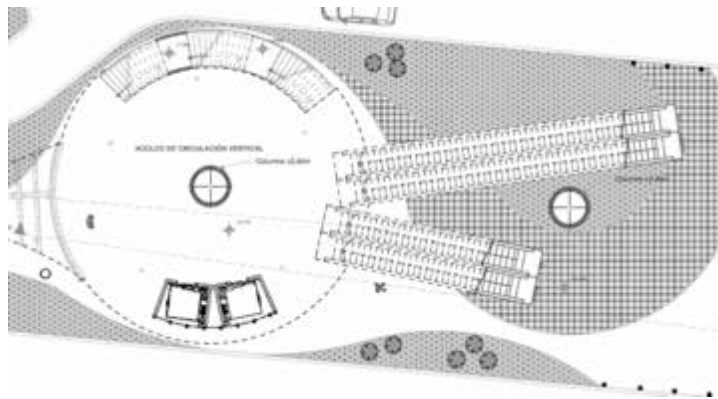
Plaza de acceso 2, planta baja (+0.17m). (2017)
